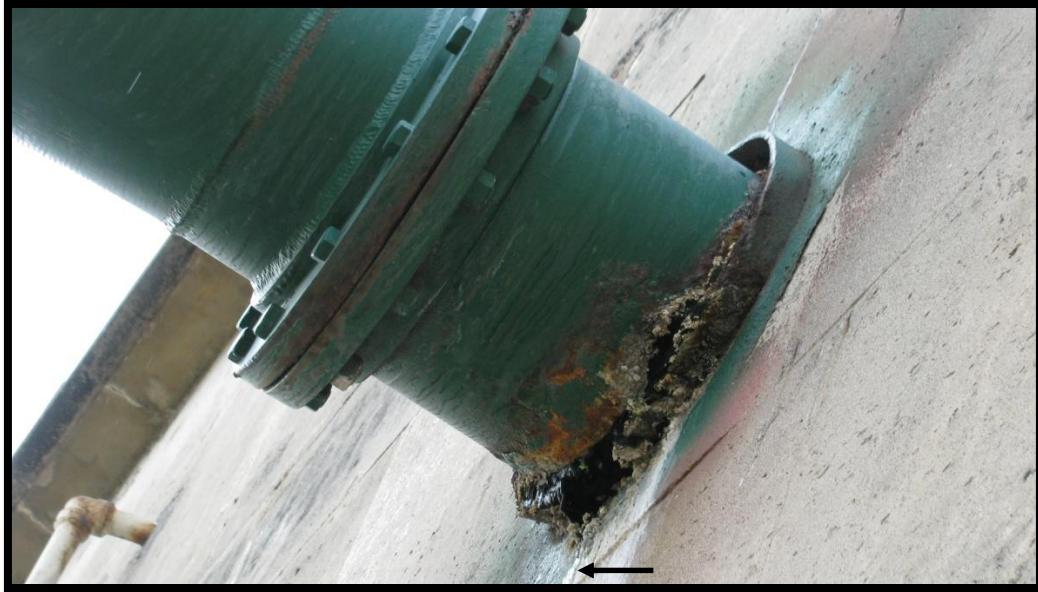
Fotografía detalle de la interacción de la tubería de bombeo con la estructura de concreto (Fuente: el autor).
